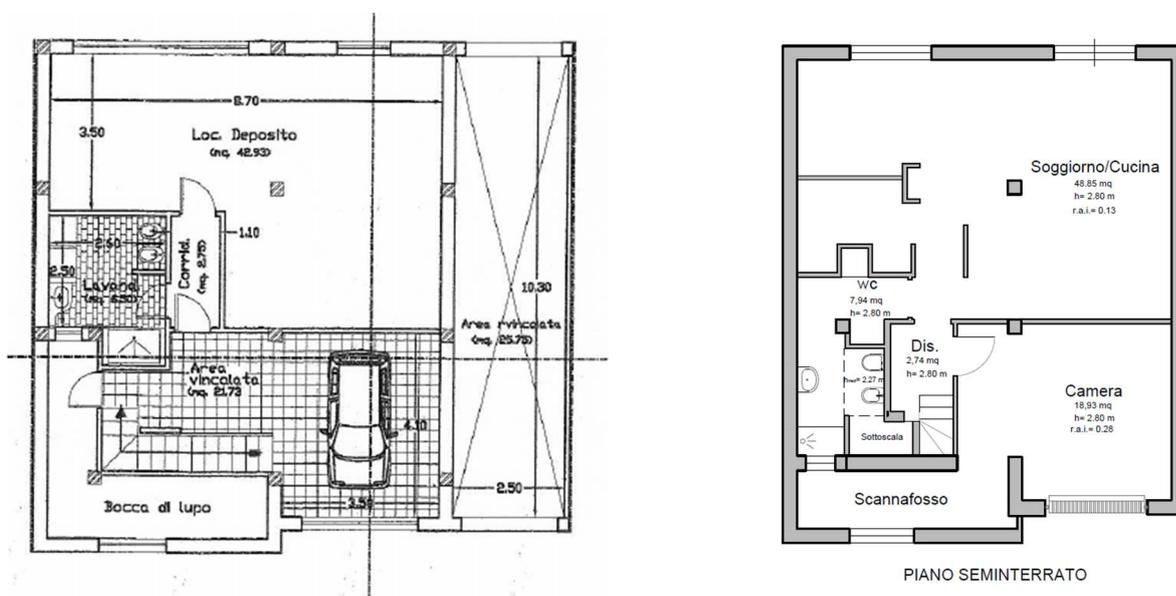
a Sx Pianta seminterrato C.E. prat.59/2006 a dx pianta stato di fatto rilevato
